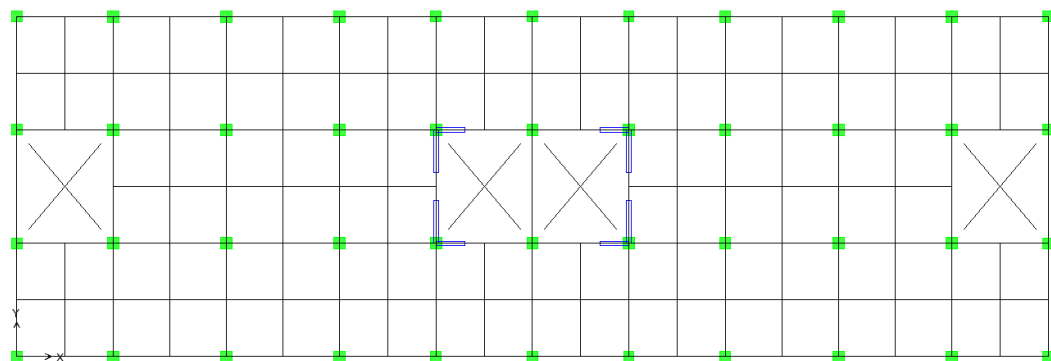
Denah Struktur Tanpa *Shearwall* (TS)
